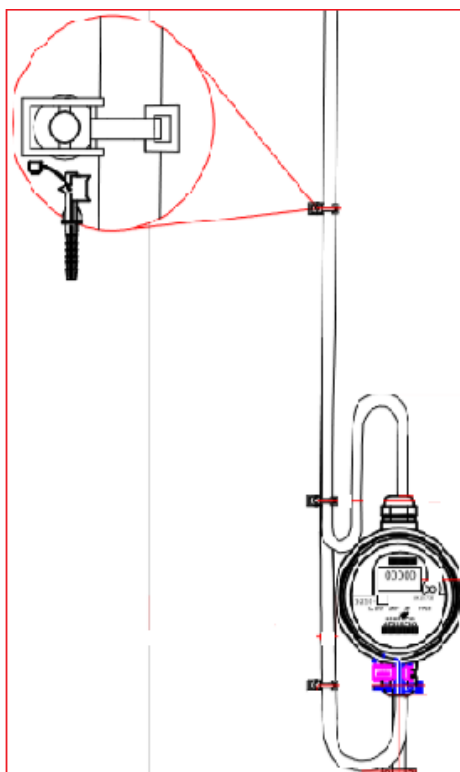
Sujeción de cable mediante collar de amarre en fachada
